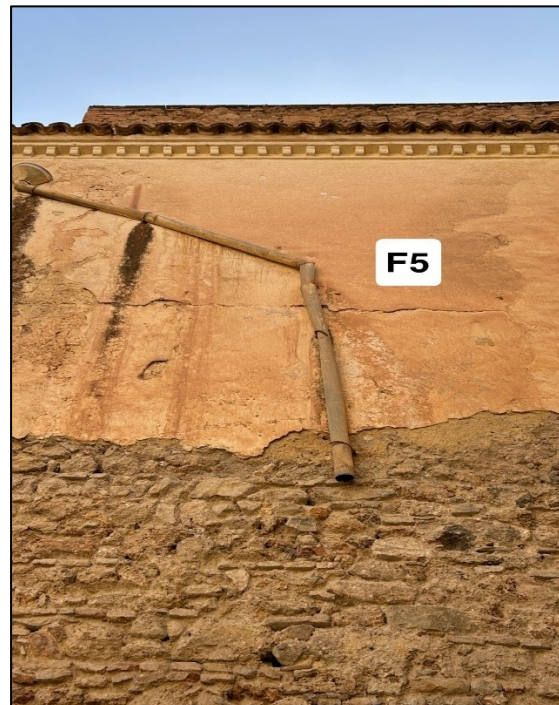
Fissuration localisée à proximité d'un réseau d'assainissement
